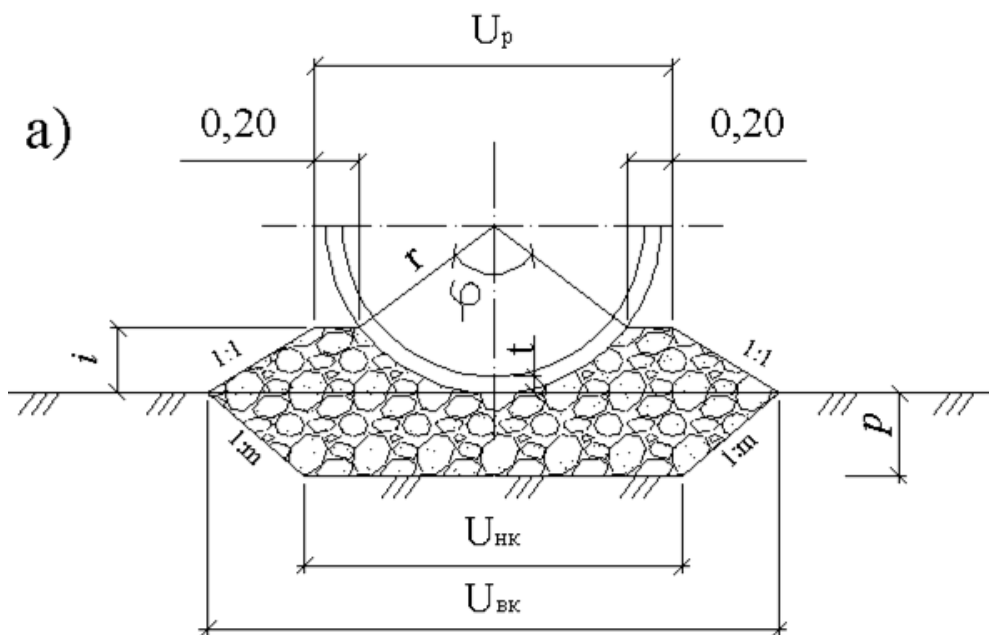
Схема к обоснованию размеров поперечного сечения бесфундаментной трубы.
